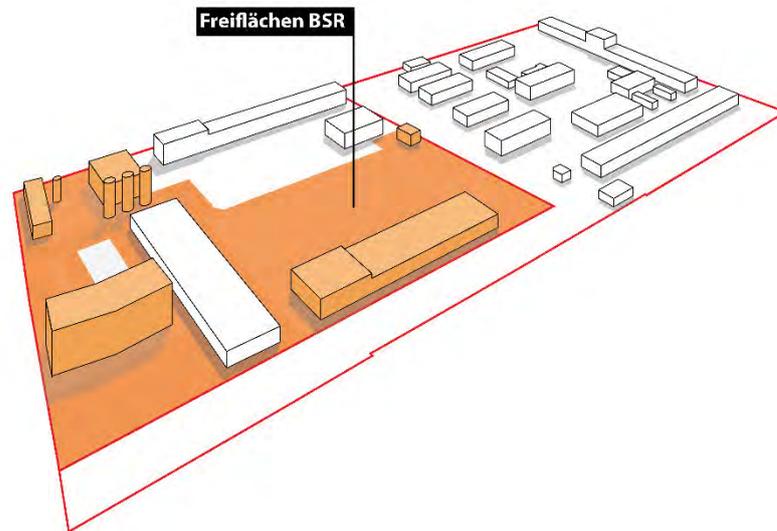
Übersichtplan Freiflächen/ Gebäude BSR (Orange)
